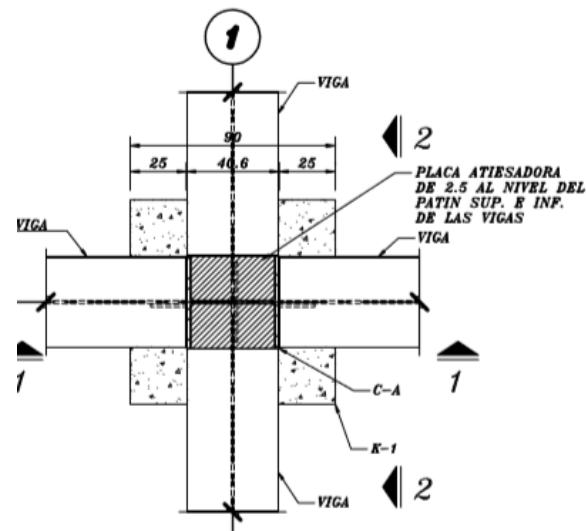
Conexión propuesta por el Ing. Raúl Granados Granados. Vista en Planta
